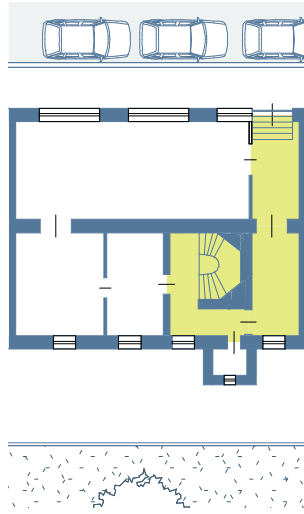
Grundriss eines Gründerzeithauses mit seitlicher Erschließung im Erdgeschoß
